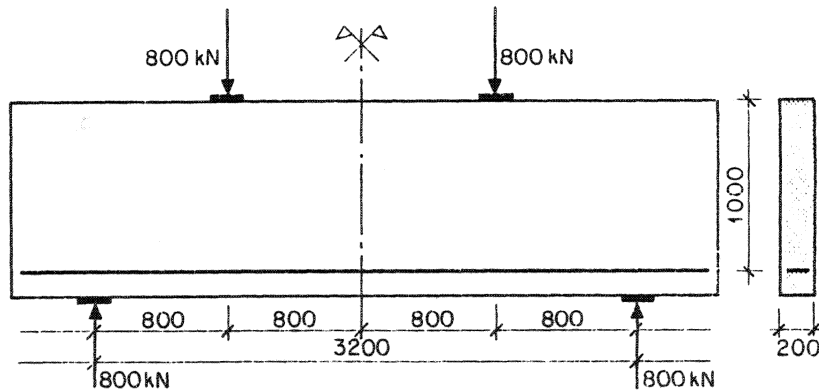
Stahlbetonträger mit Abmessungen und Belastung
